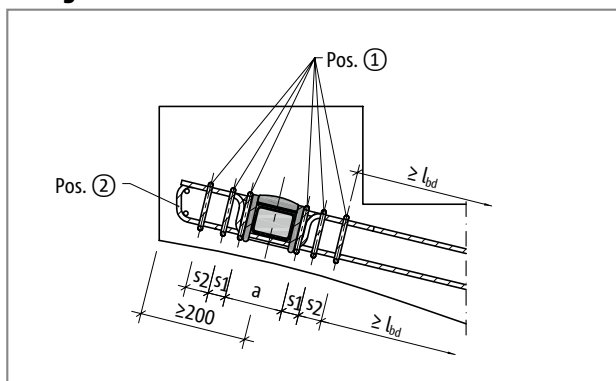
Schöck Tronsole® tipo Q, Vista "punto testa"
